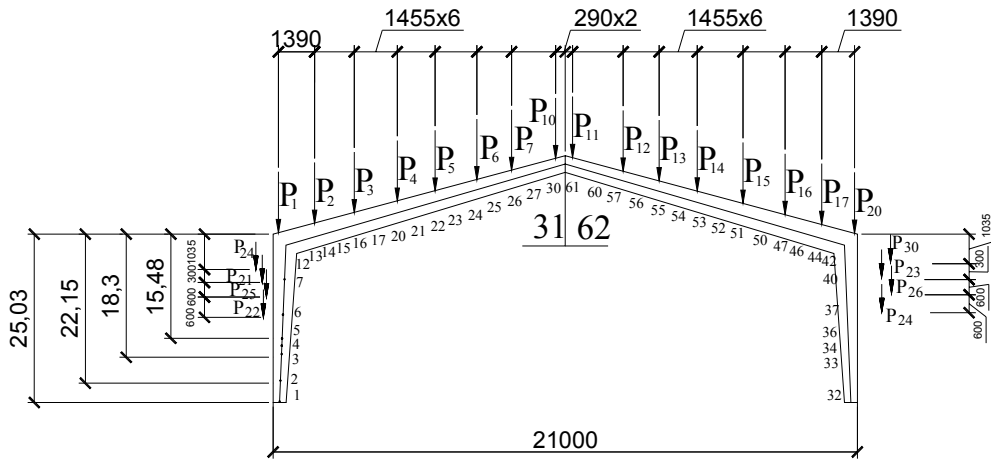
Розрахункова схема і схема прикладання одиничного навантаження до ригеля та стійки рами
